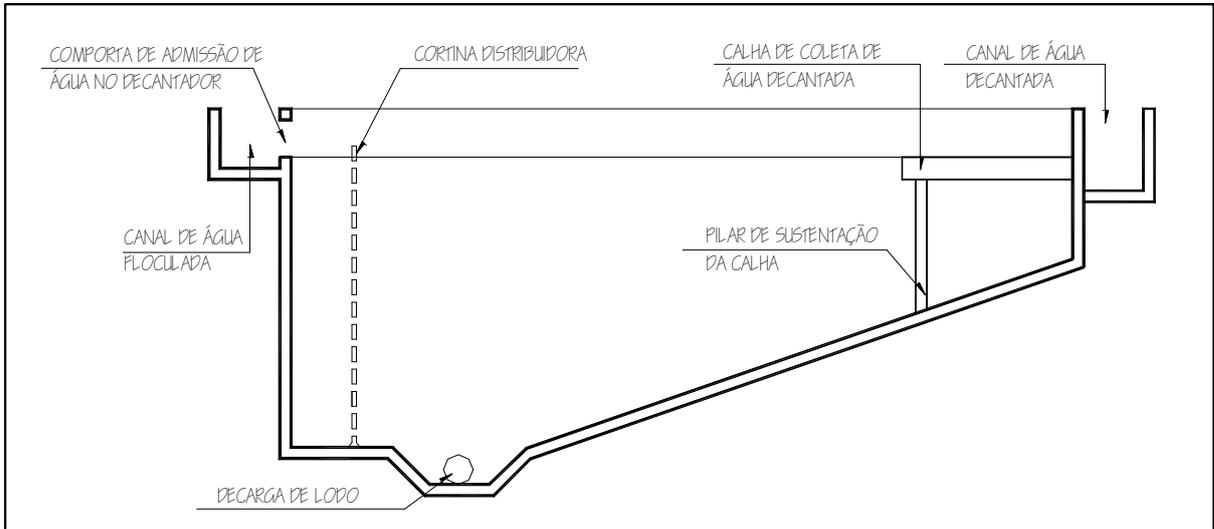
Detalhe da cortina distribuidora de água no decantador
